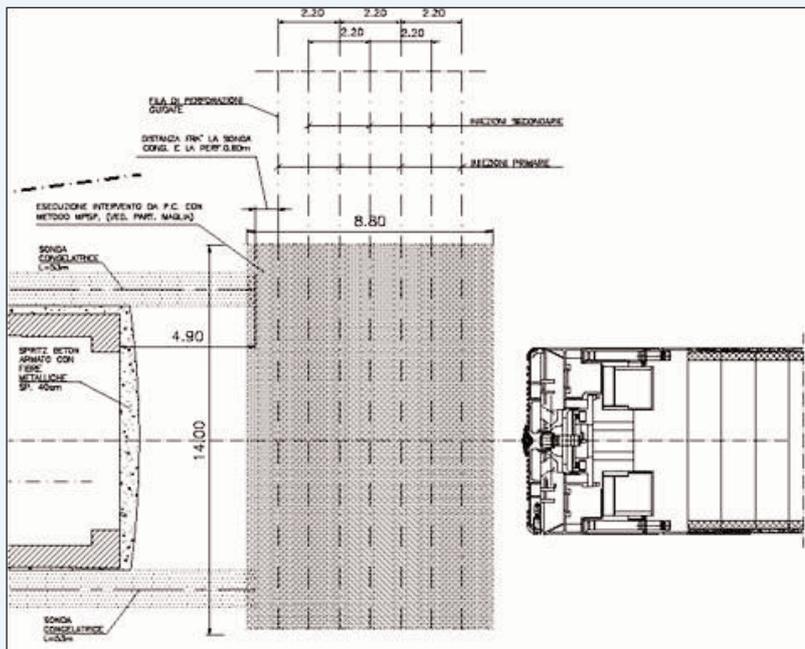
Il tampone di fondo eseguito dal piano campagna: la sezione longitudinale
